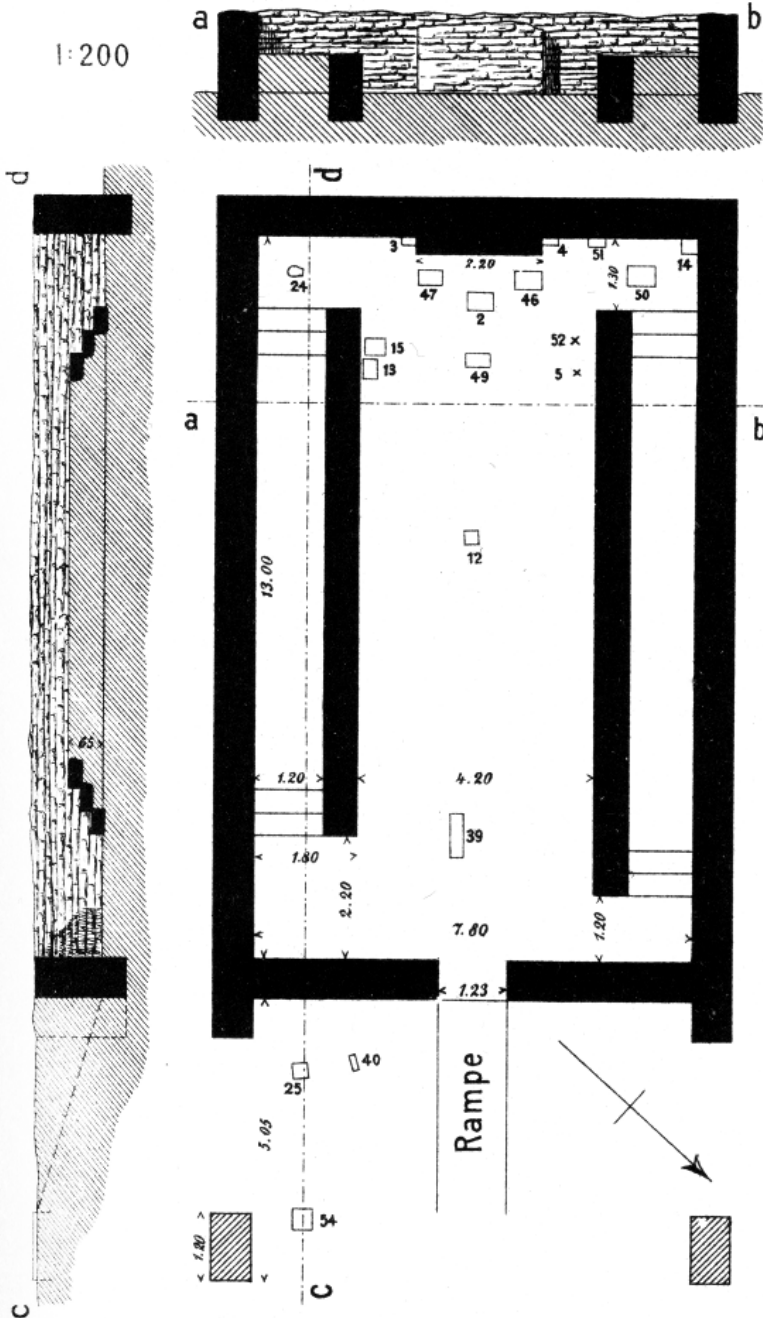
Grundriss des Mithräums 1 in Stockstadt (CIMRM II 1158)
